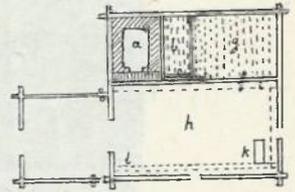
Grundriss des hauses in abb. 5.
